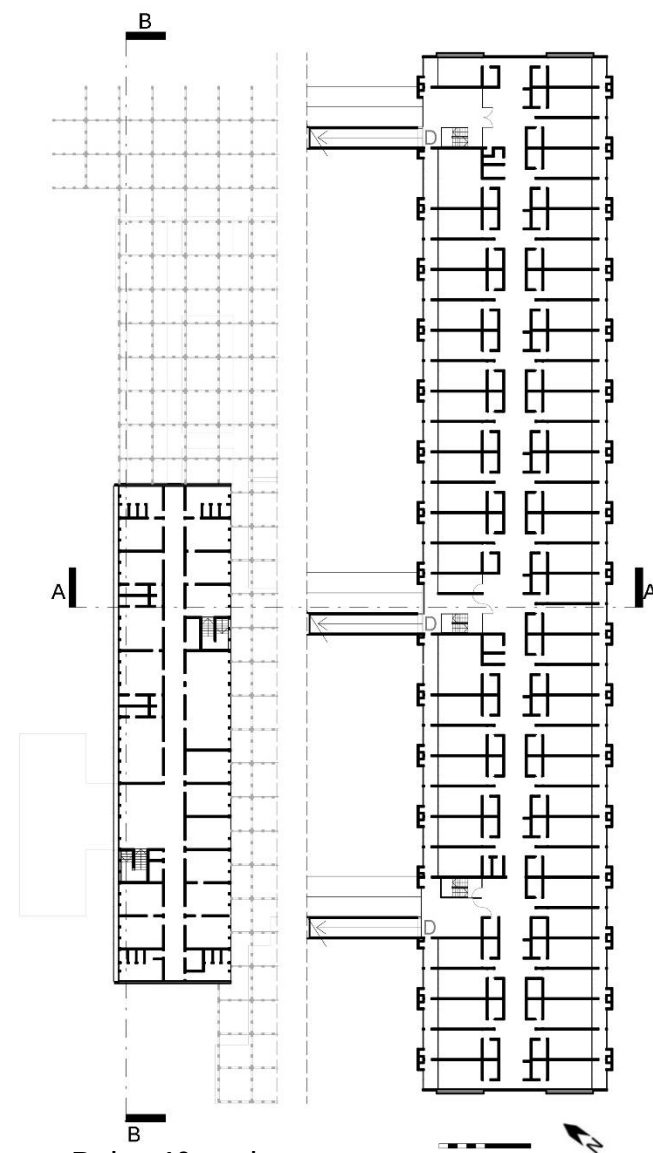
Plantas baixas do Hospital Geral da Guarnição do Galeão (HGG).
